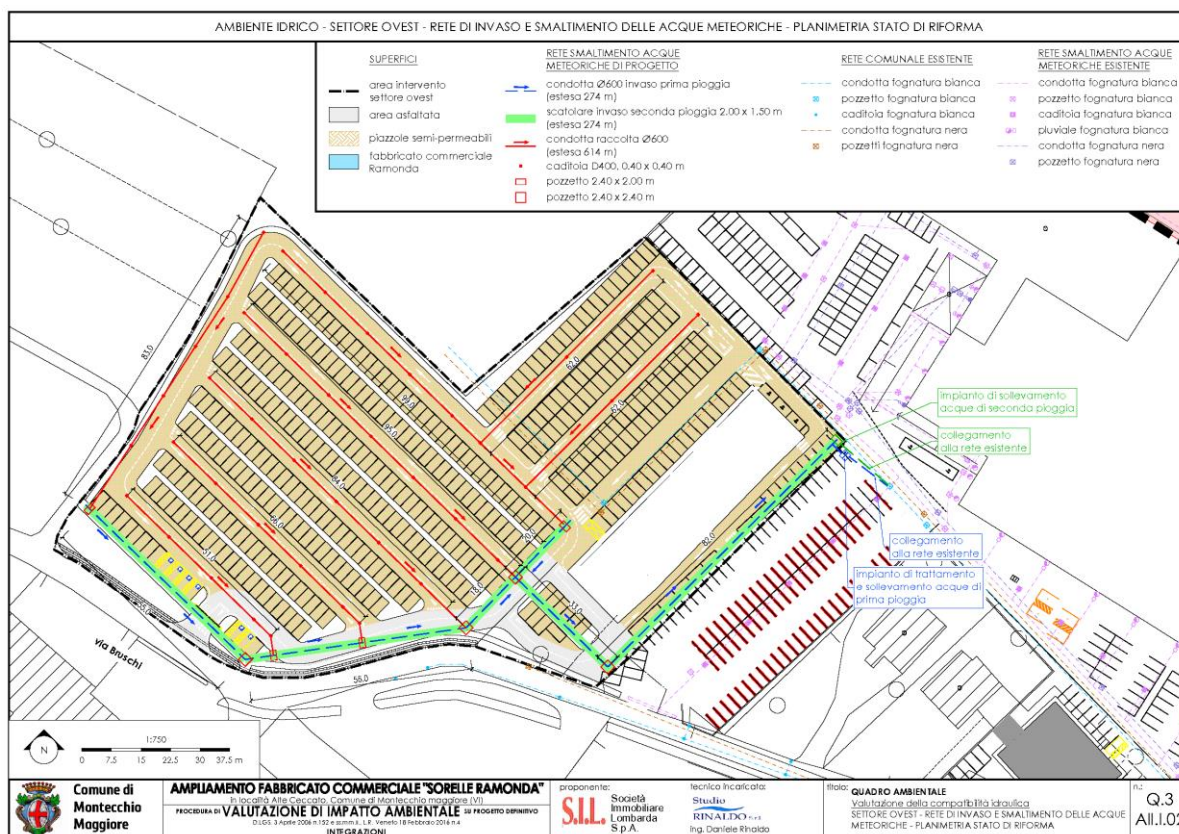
planimetria generale rete di invaso e smaltimento acque meteoriche
